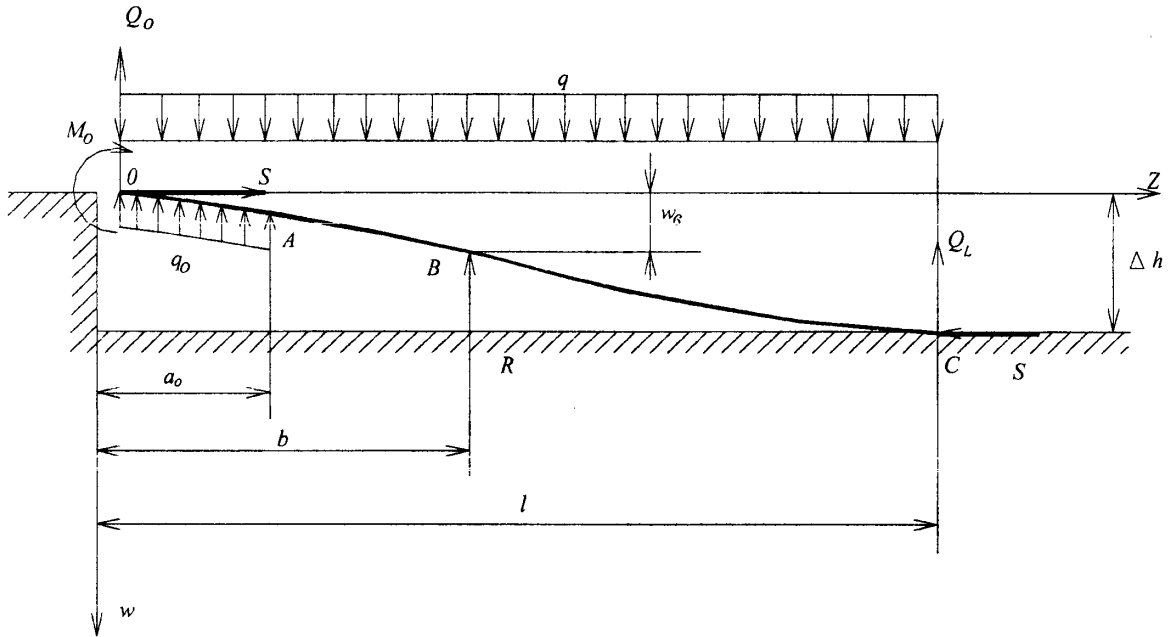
Розрахункова схема підсадки трубопроводу
